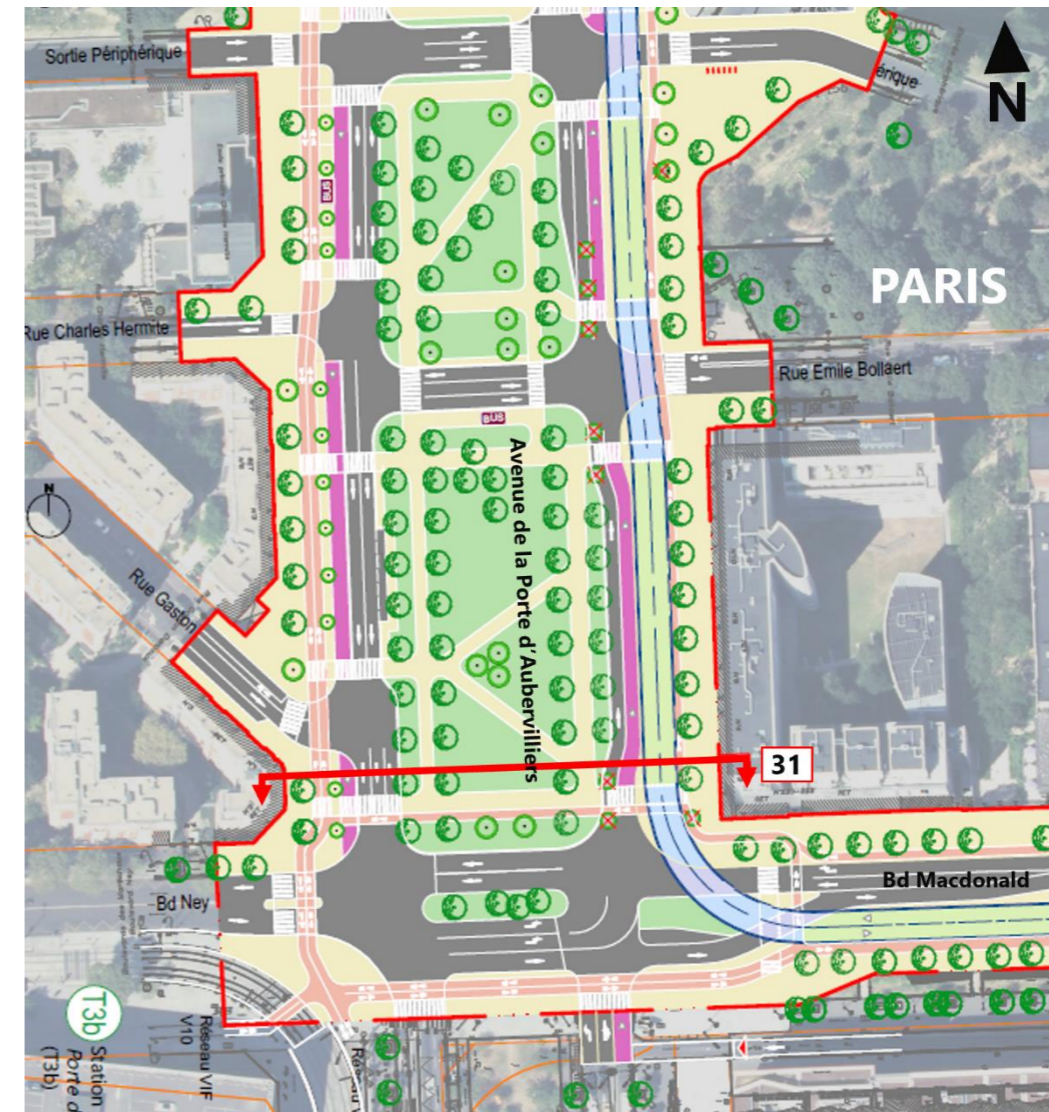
Plan d’insertion du projet T8 Sud – Séquence 4.3 – Avenue de la Porte d’Aubervilliers sud
